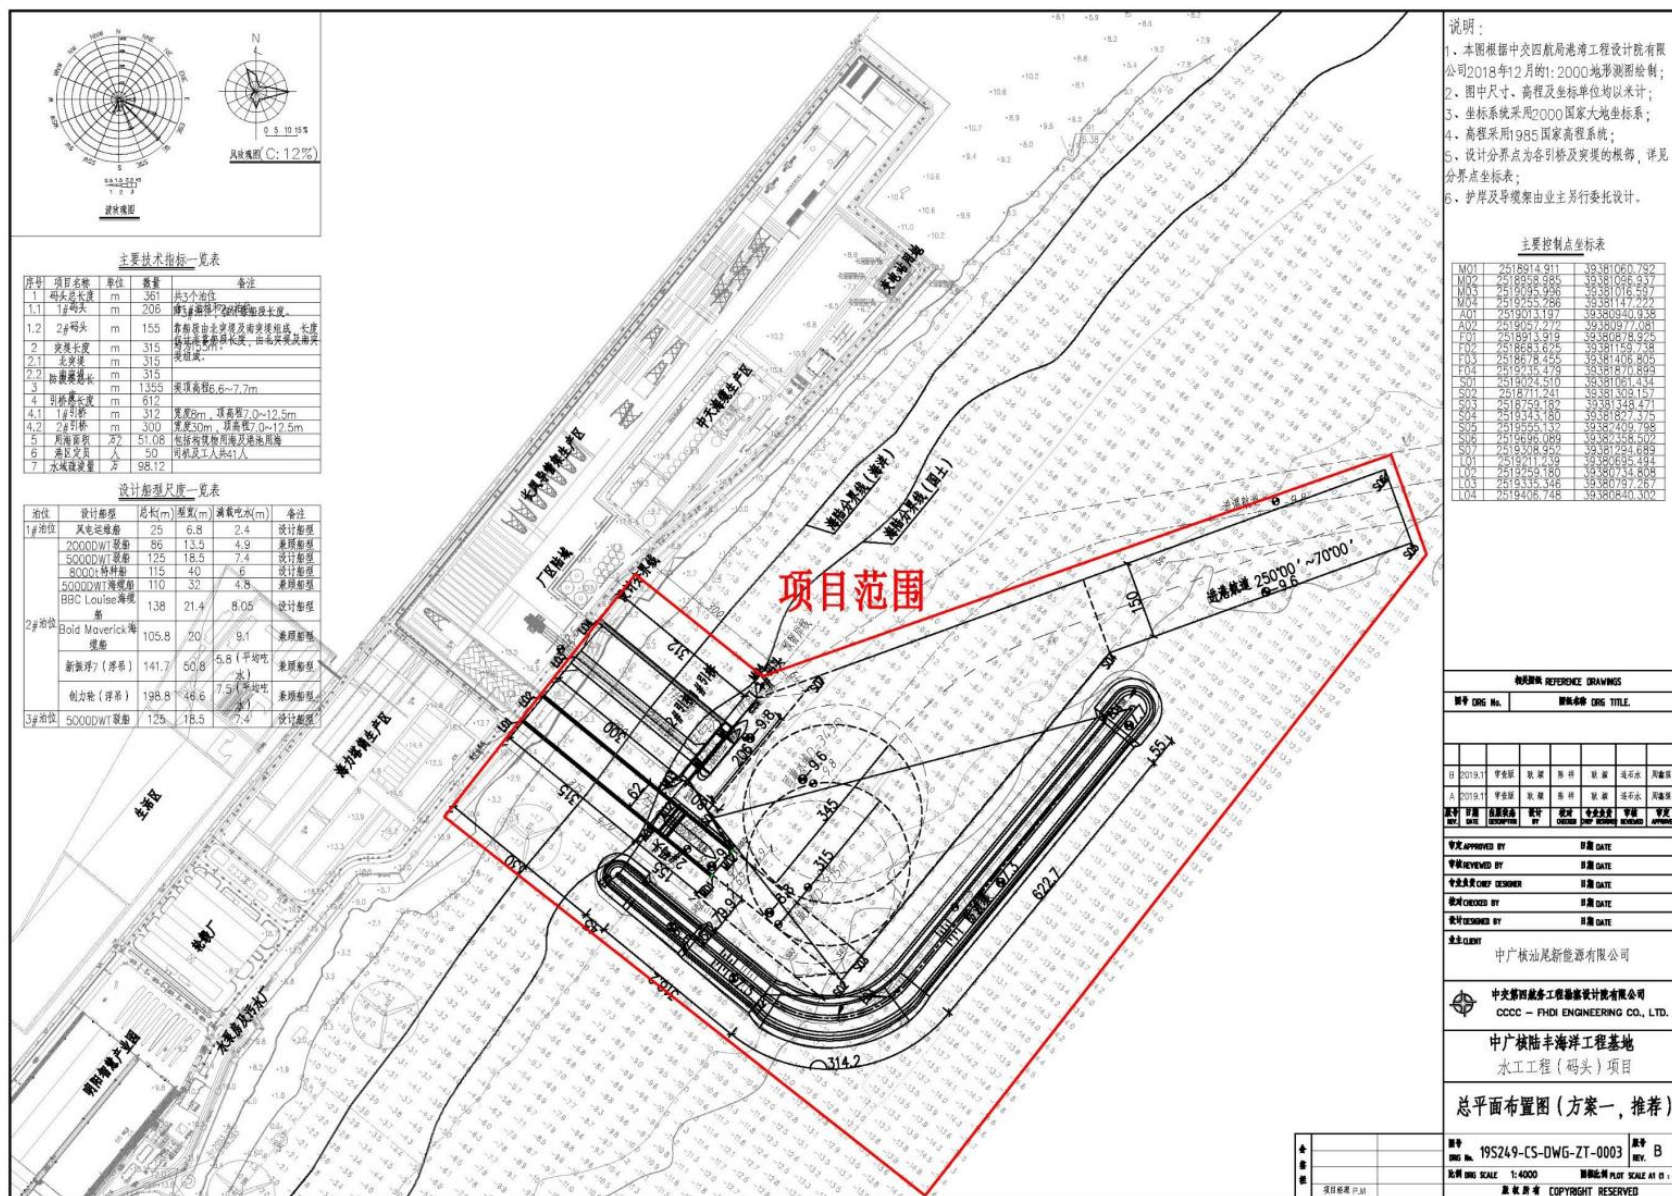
中广核陆丰海洋工程基地水工工程总平面布置图
